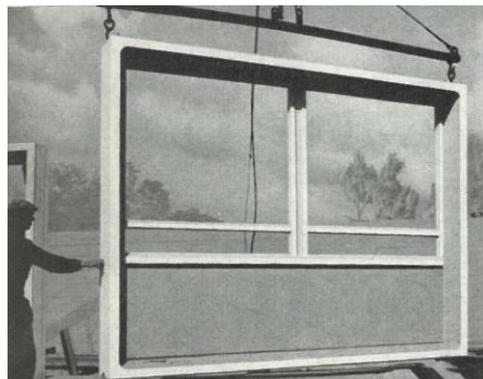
Photo d'un élément de façade préfabriqué en Schokbeton.
